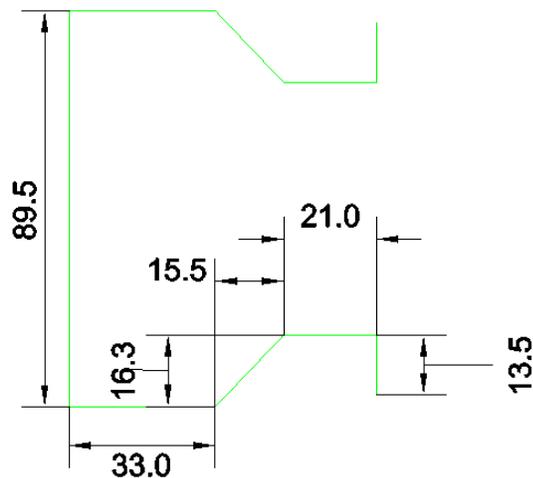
Perfil da coluna a ser analisado (dimensões em milímetro).
